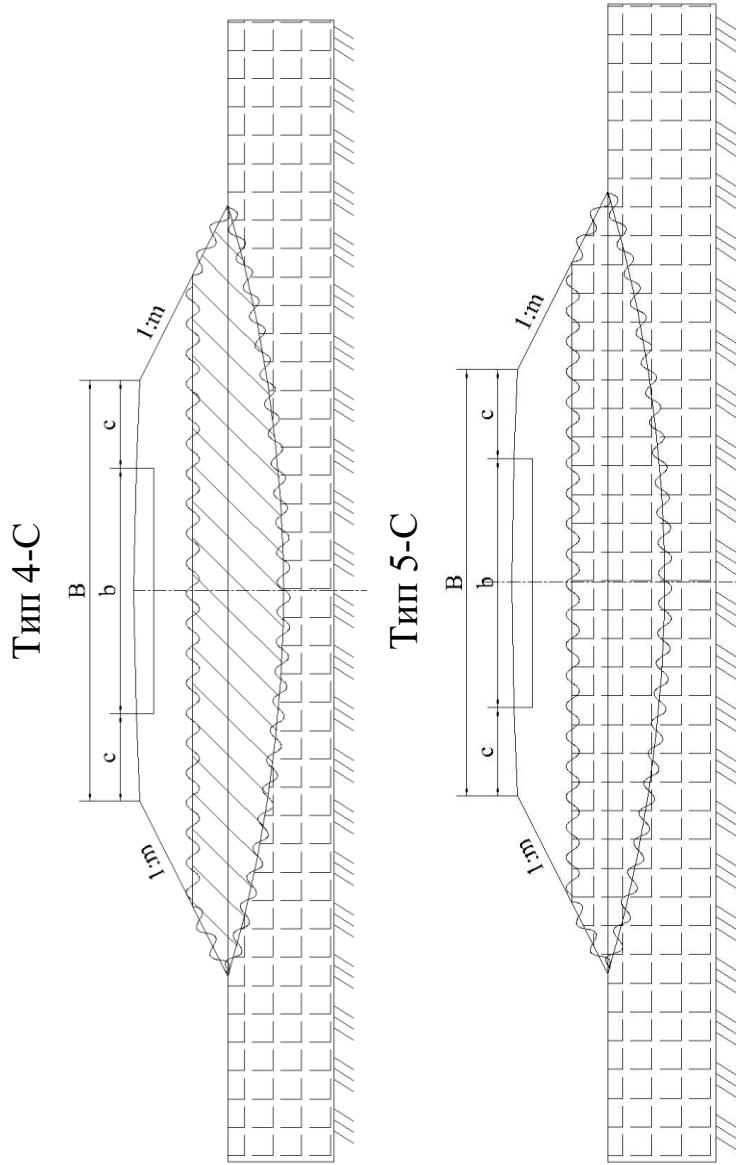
Насыпи на слабых грунтах с армированием нижней части обоймой из геотекстиля
